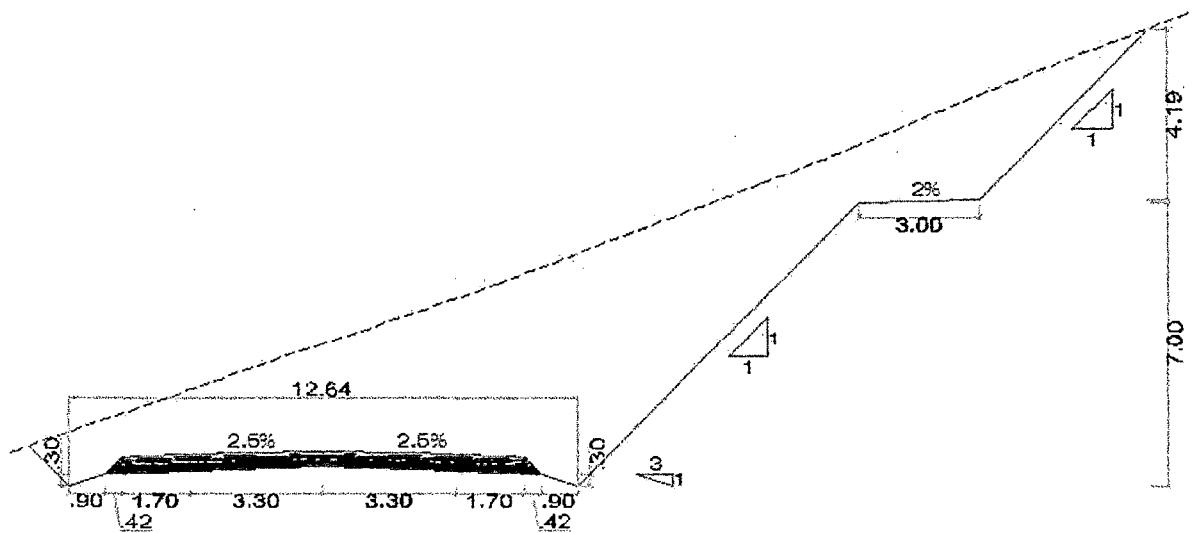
Sección transversal (en corte) en tangente con banquetas - Fuente. Elaboración Propia
